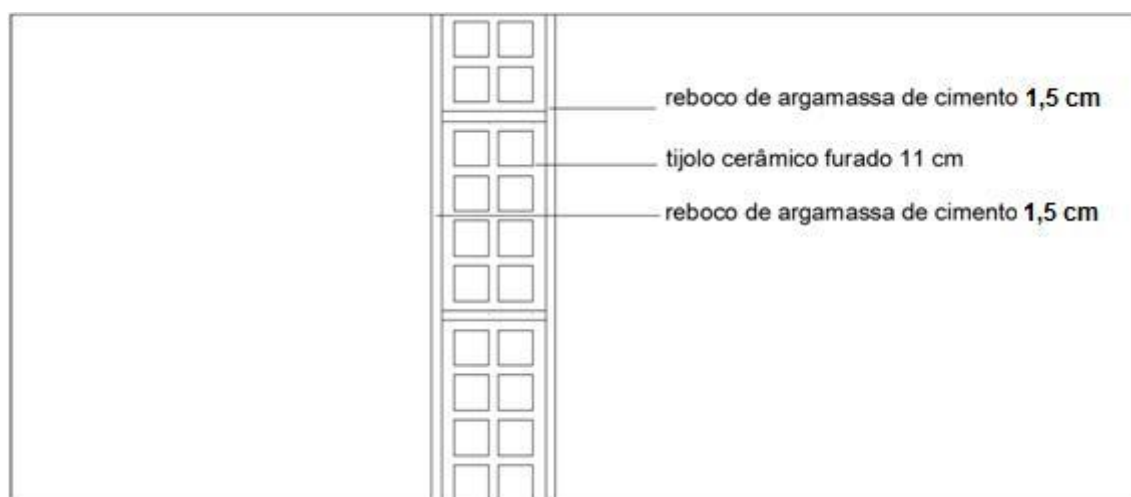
Pormenor construtivo de parede interior de compartimentação da solução existente
